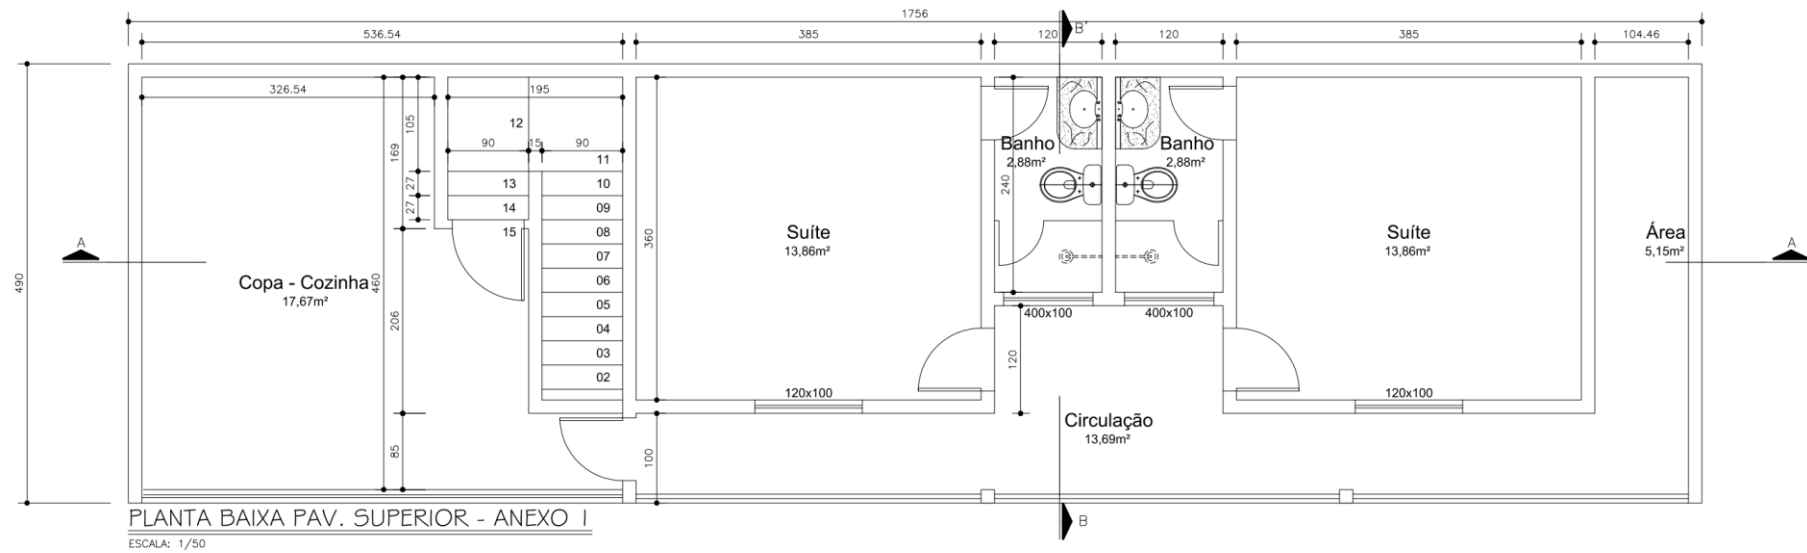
Planta baixa do 1º Piso do anteprojeto arquitetônico.
